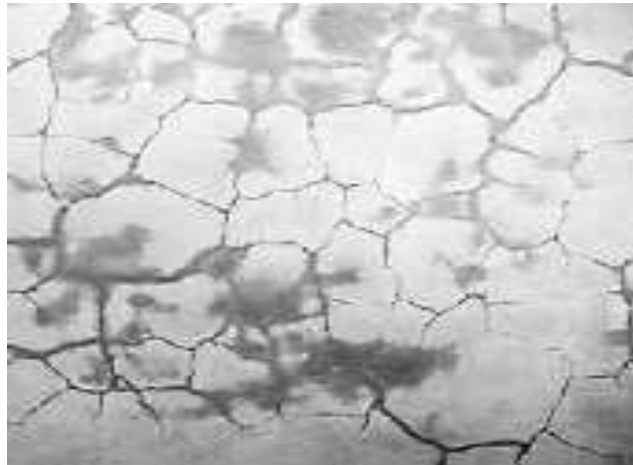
Fissuração em paredes (Autor, 2017)
